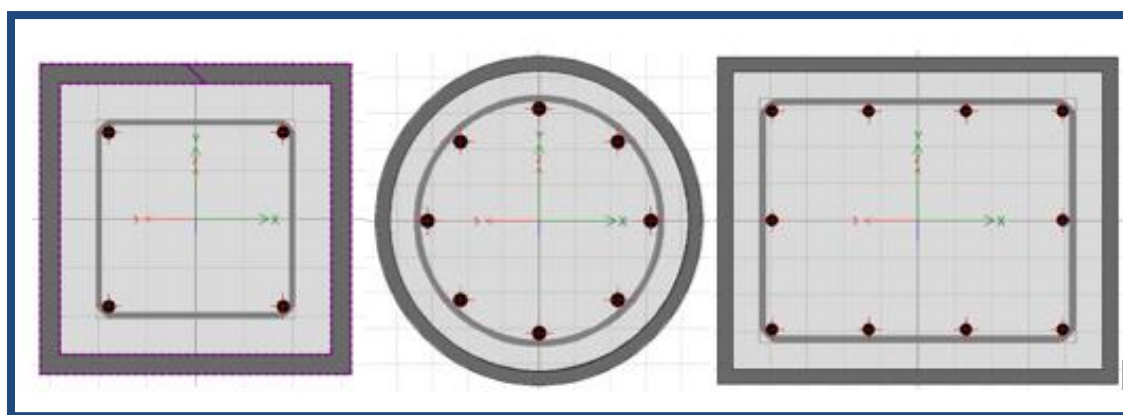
Encamisado de columnas del edificio # 2 Fuente: Propia
